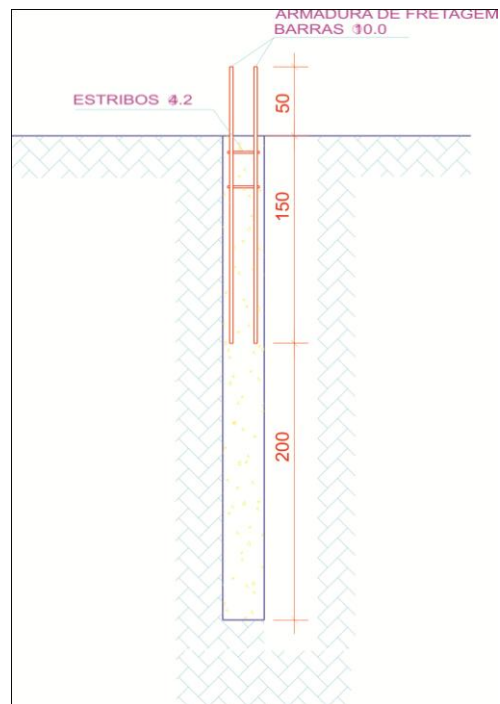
Vista em corte, destacando a posição da armadura de fretagem.
